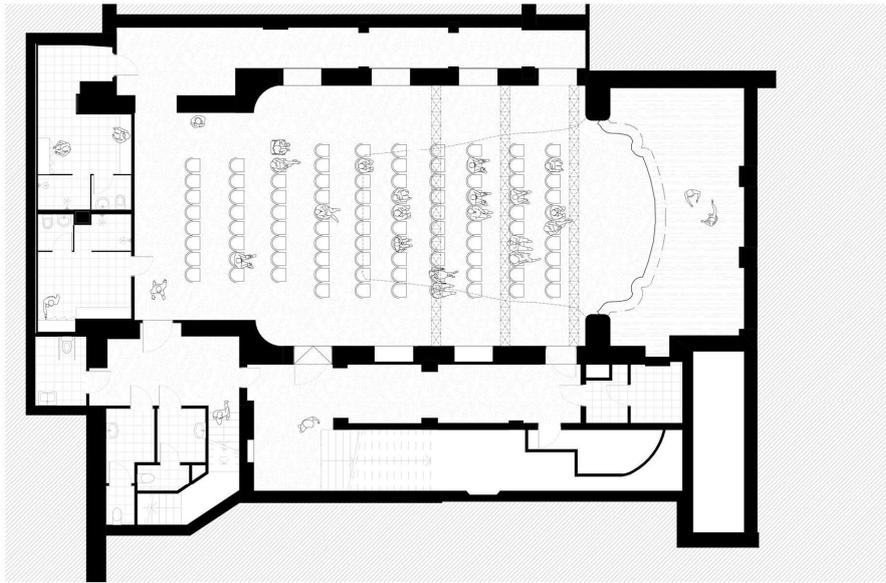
Planimetrie di progetto del caffè Muller dello studio Plac, pianta piano terra, 2017
